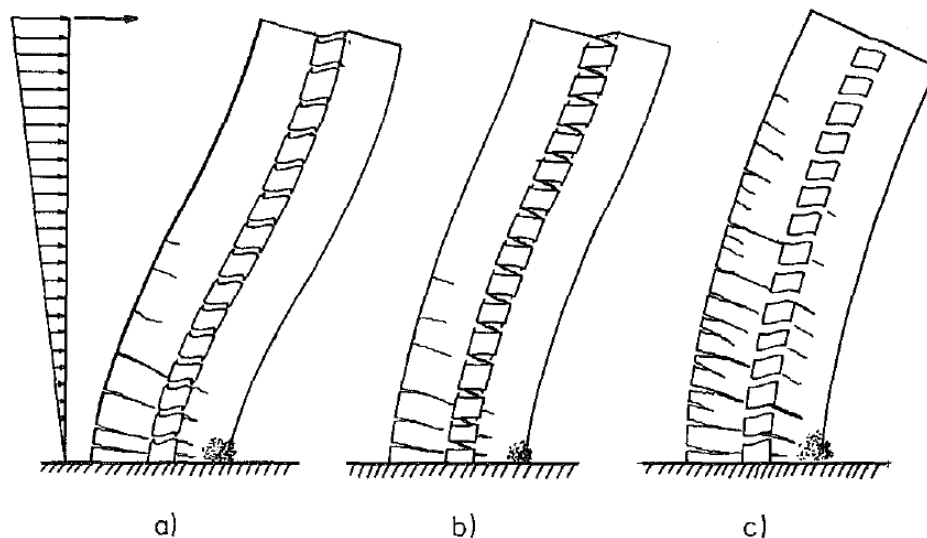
Modos de falla del sistema acoplado a) Vigas de acople fallan por flexión; b) vigas de acople fallan por corte; c) vigas de acople rígidas (Subedi, 1991)
